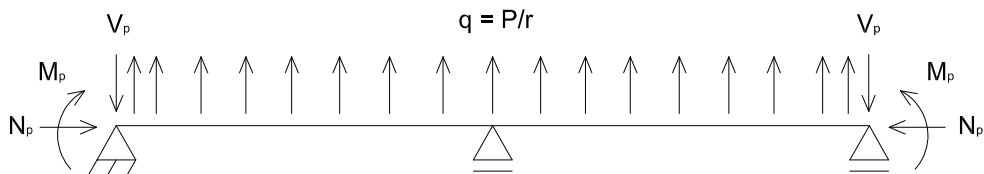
Viga hiperestática submetida às ações de protensão.
